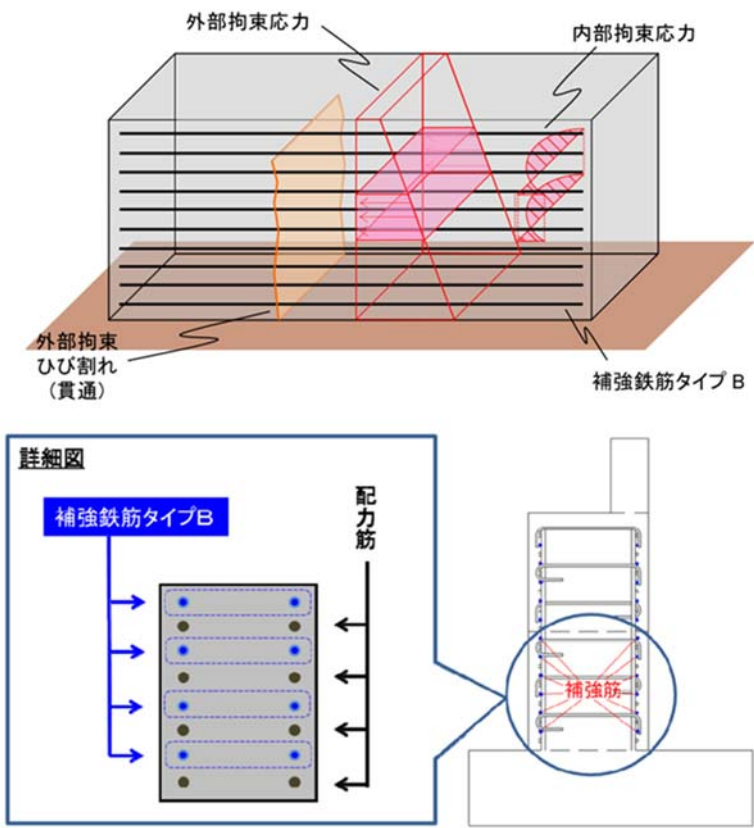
ひび割れ発生方向と抵抗鉄筋概要図(補強鉄筋タイプB)
